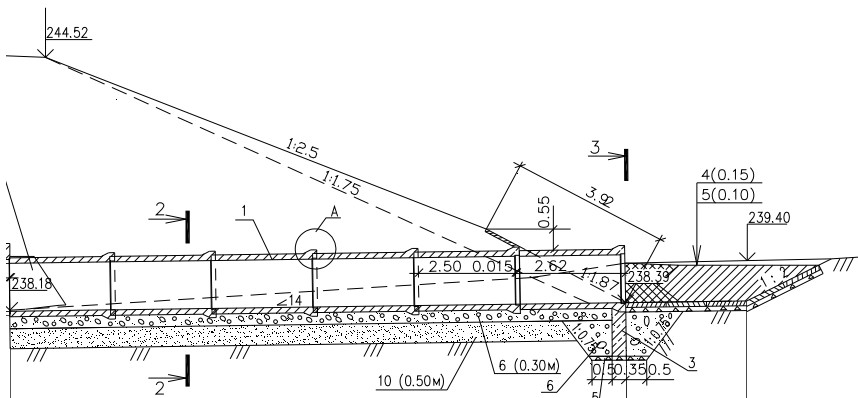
Удлинение круглой водопропускной трубы на входе
